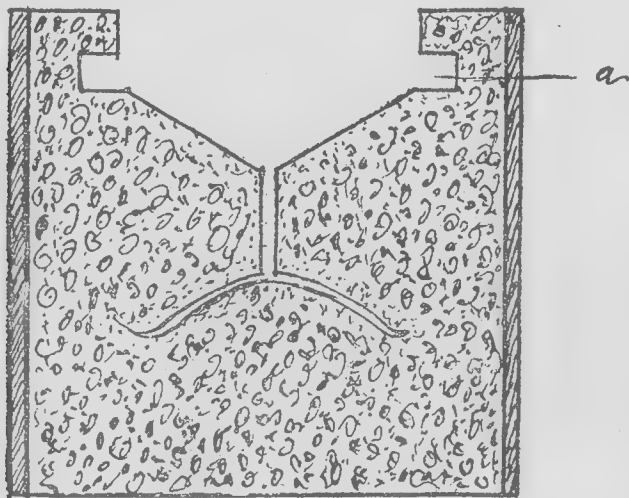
Section verticale de cylindre montrant en a la gouttière laissée par l'anneau de caoutchouc.
